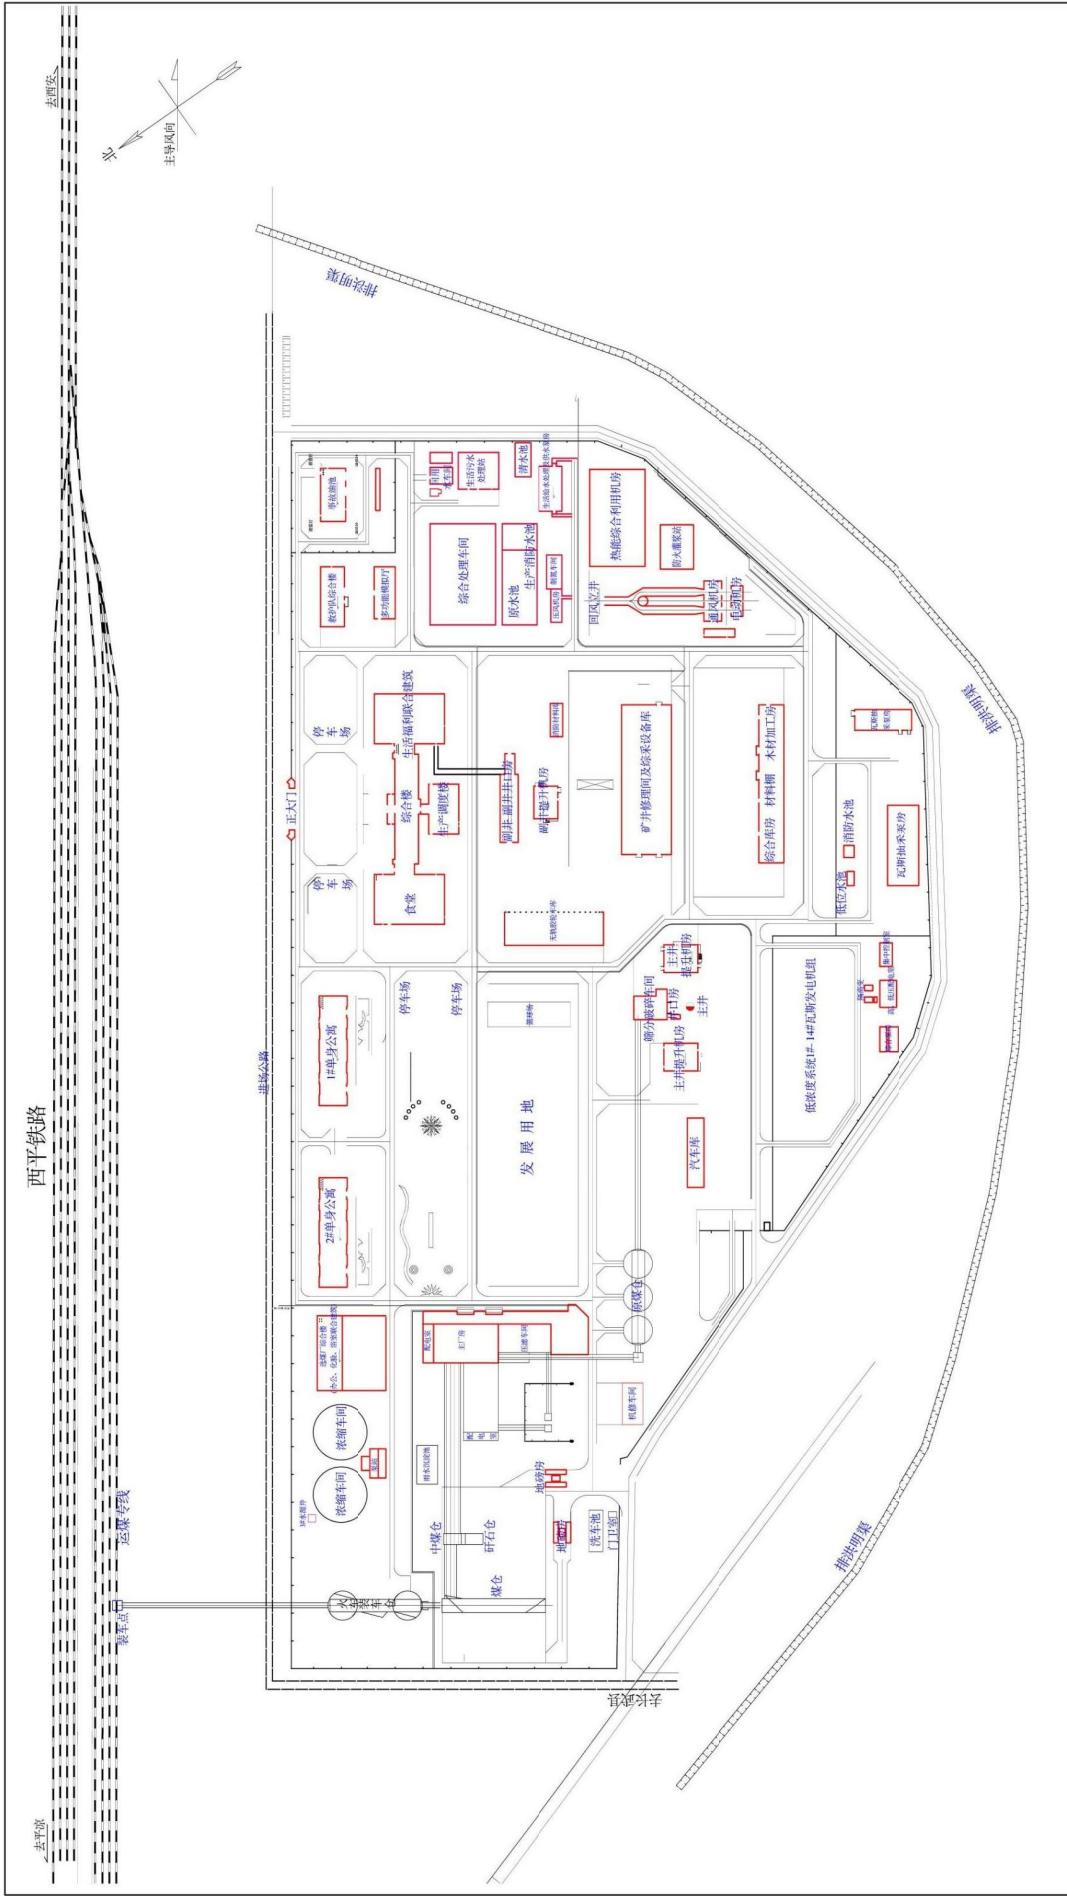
长武县高家堡煤矿工业场地平面布置示意图
